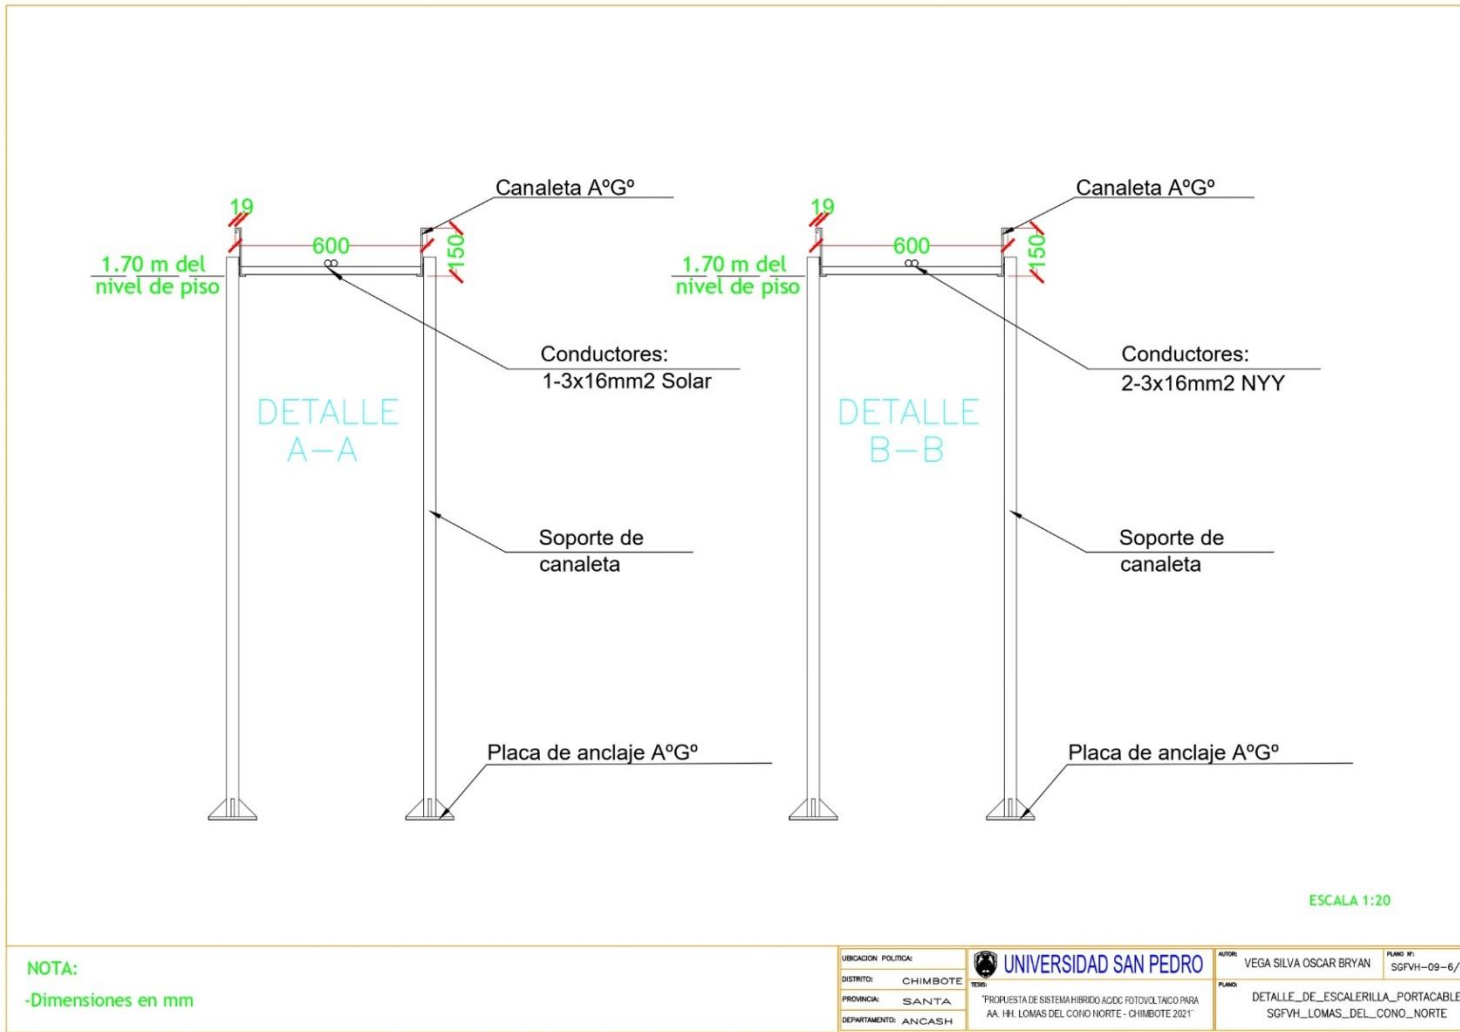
Detalle de Escalera Portacable Vista Frontal Detalle A y B_SGFVH.
